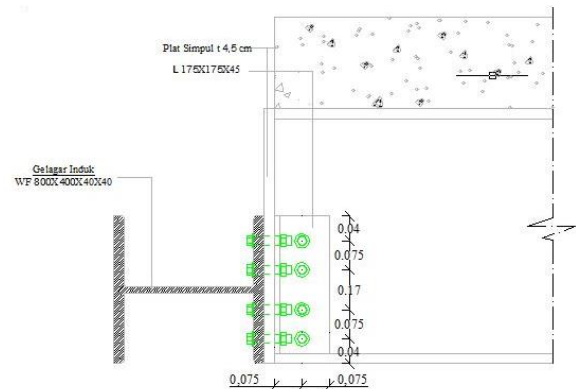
Detail Sambungan Gelagar Melintang dan Memanjang
